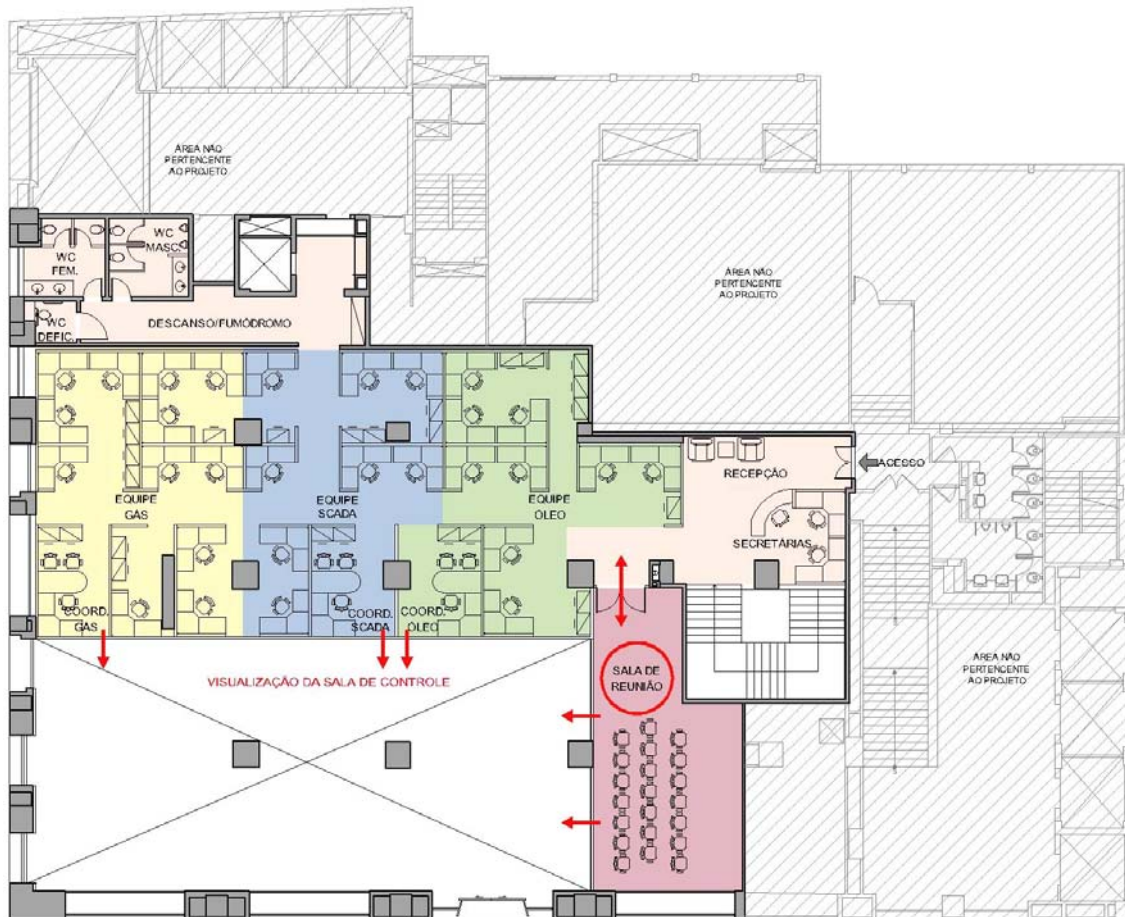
Planta baixa mezanino: opção 1 para o layout (dois de junho)
